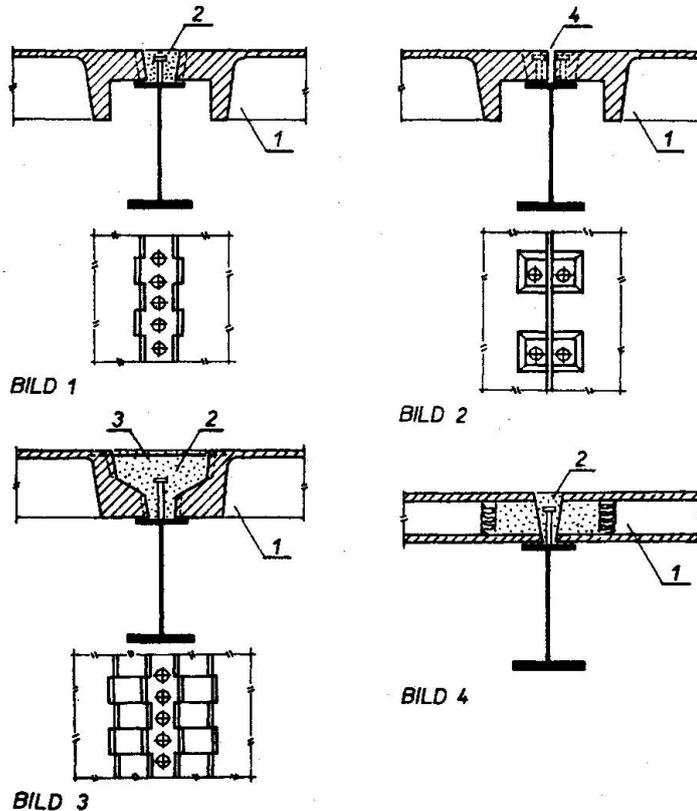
4. Stahlträger in Verbund mit Fertigbetondeckenplatten (1-Fertigbetondeckenplatten, 2-Betonverguss, 3-verschweisste Bewehrung, 4-Fuge)
